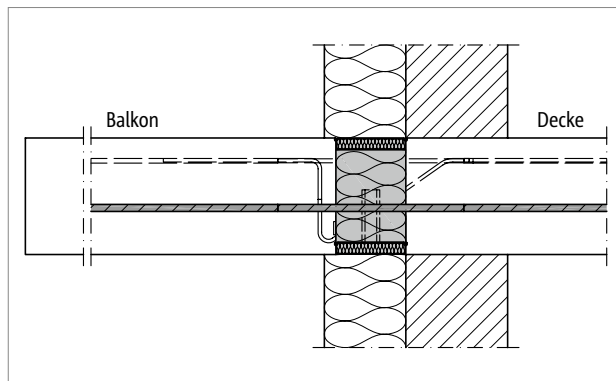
Schöck Isokorb® XT Typ KL, HP-NN: Mauerwerk mit Außendämmung
